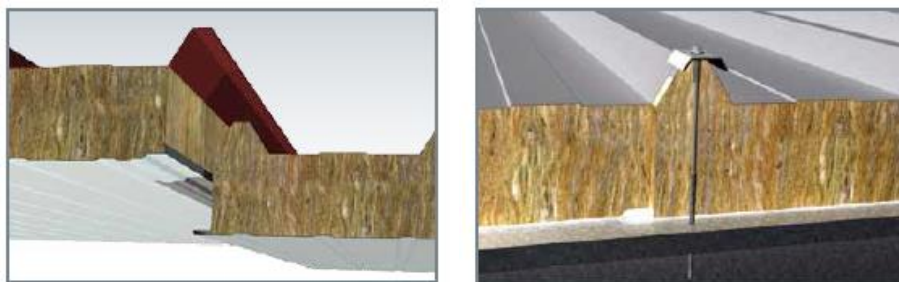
Pormenor das juntas entre painéis sandwich na direção longitudinal. Extraído do catálogo da empresa
